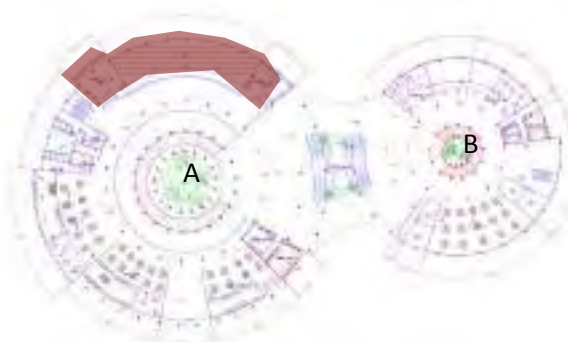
Denah Lantai 2 , (dok.pribadi)
